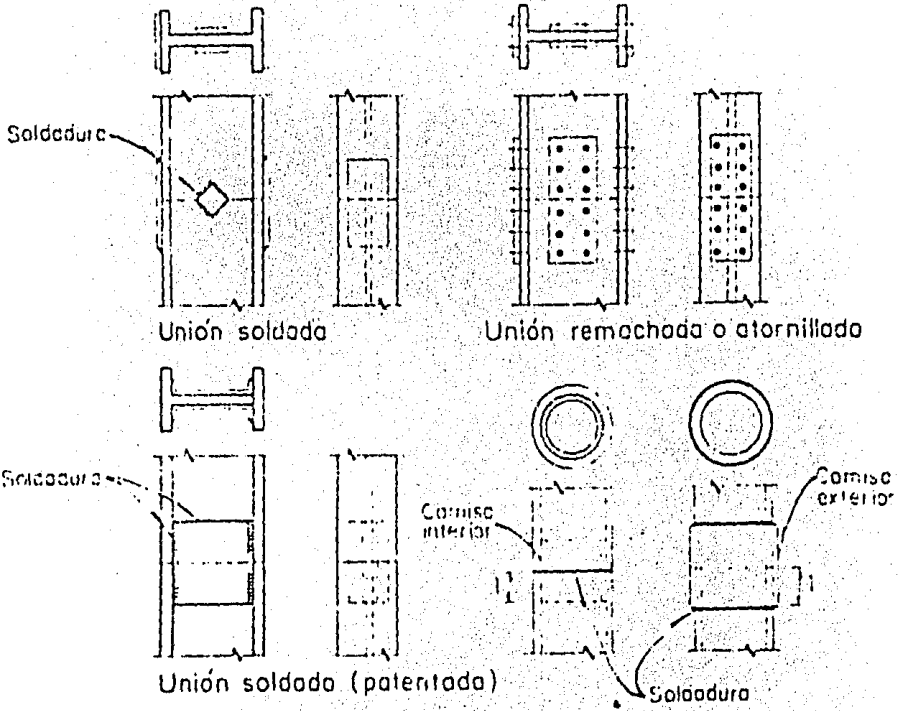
Uniones típicas de pilotes de acero estructural
